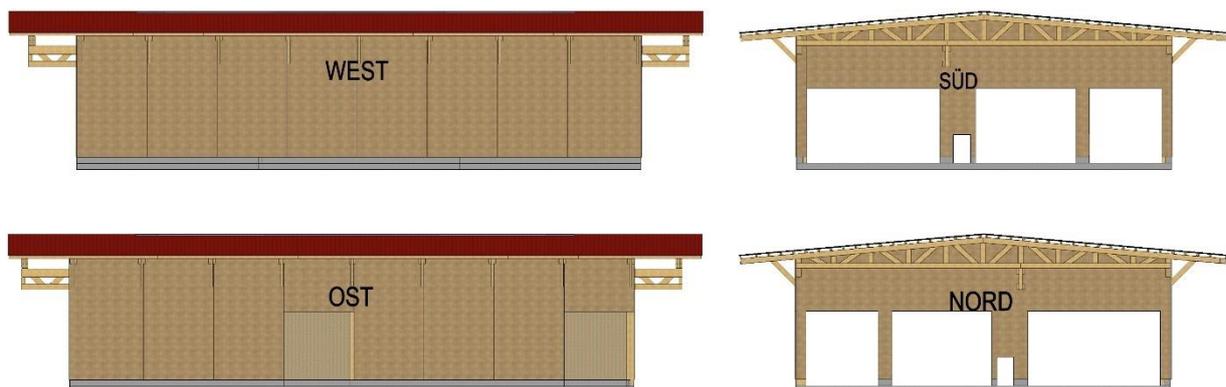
Planungsstand Bauvorhaben Produktionshalle mit reduzierter Grundfläche (30x45 m): Ansichten
